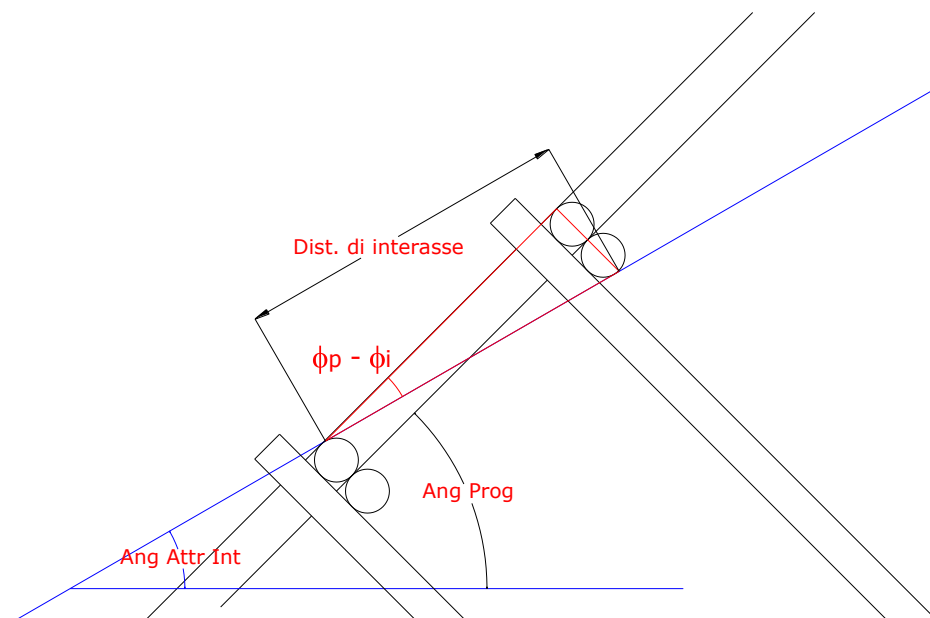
Sezione tipo della distanza d'interasse tra gli elementi orizzontali della grata Vesuvio secondo Menegazzi.
